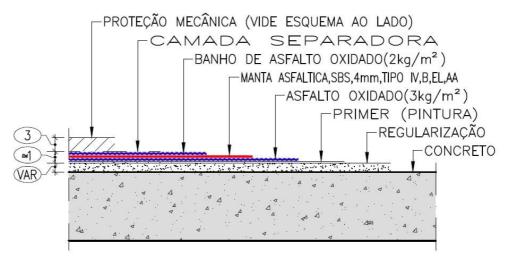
Detalhe de sequência para execução de impermeabilização com manta asfáltica.
